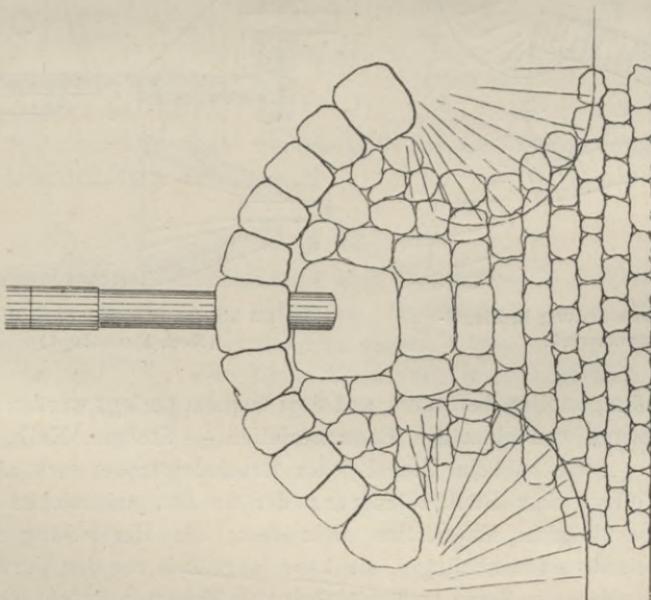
Ausmündung mit Vorbau. Grundriß.
